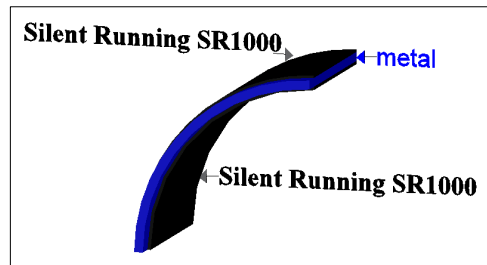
Cubierta metálica con la aplicación de SILENT RUNNING SR1000.
